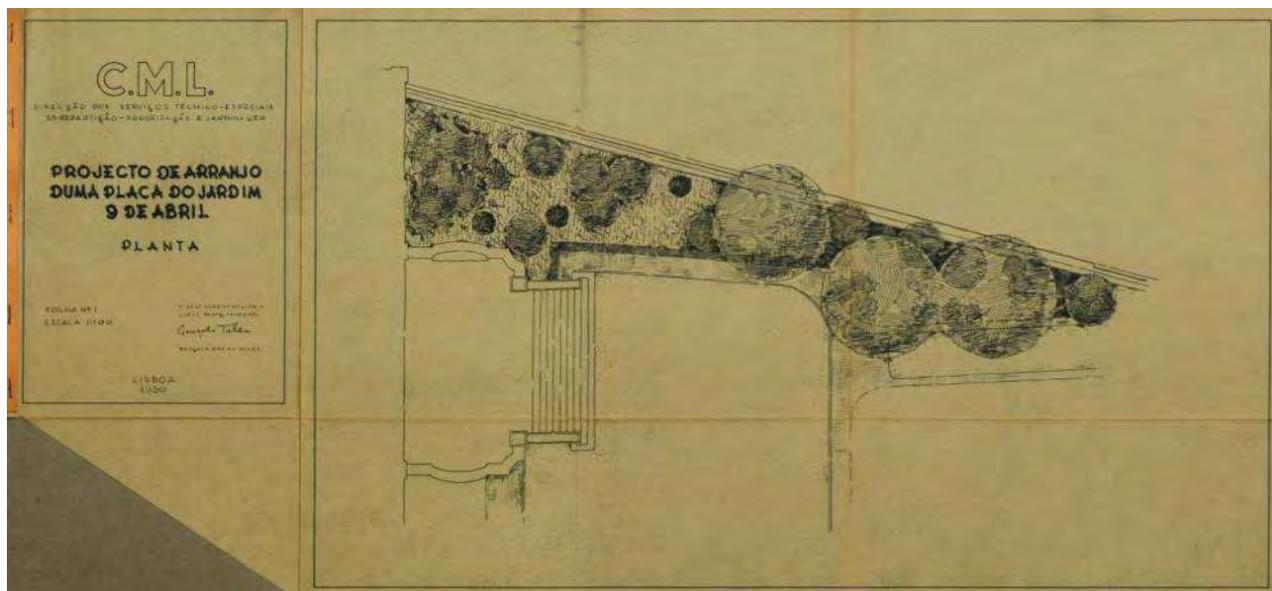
Planta do Projeto de Arranjo duma placa do Jardim 9 de Abril, da autoria do Arquiteto paisagista Gonçalo Ribeiro Telles (1950)
